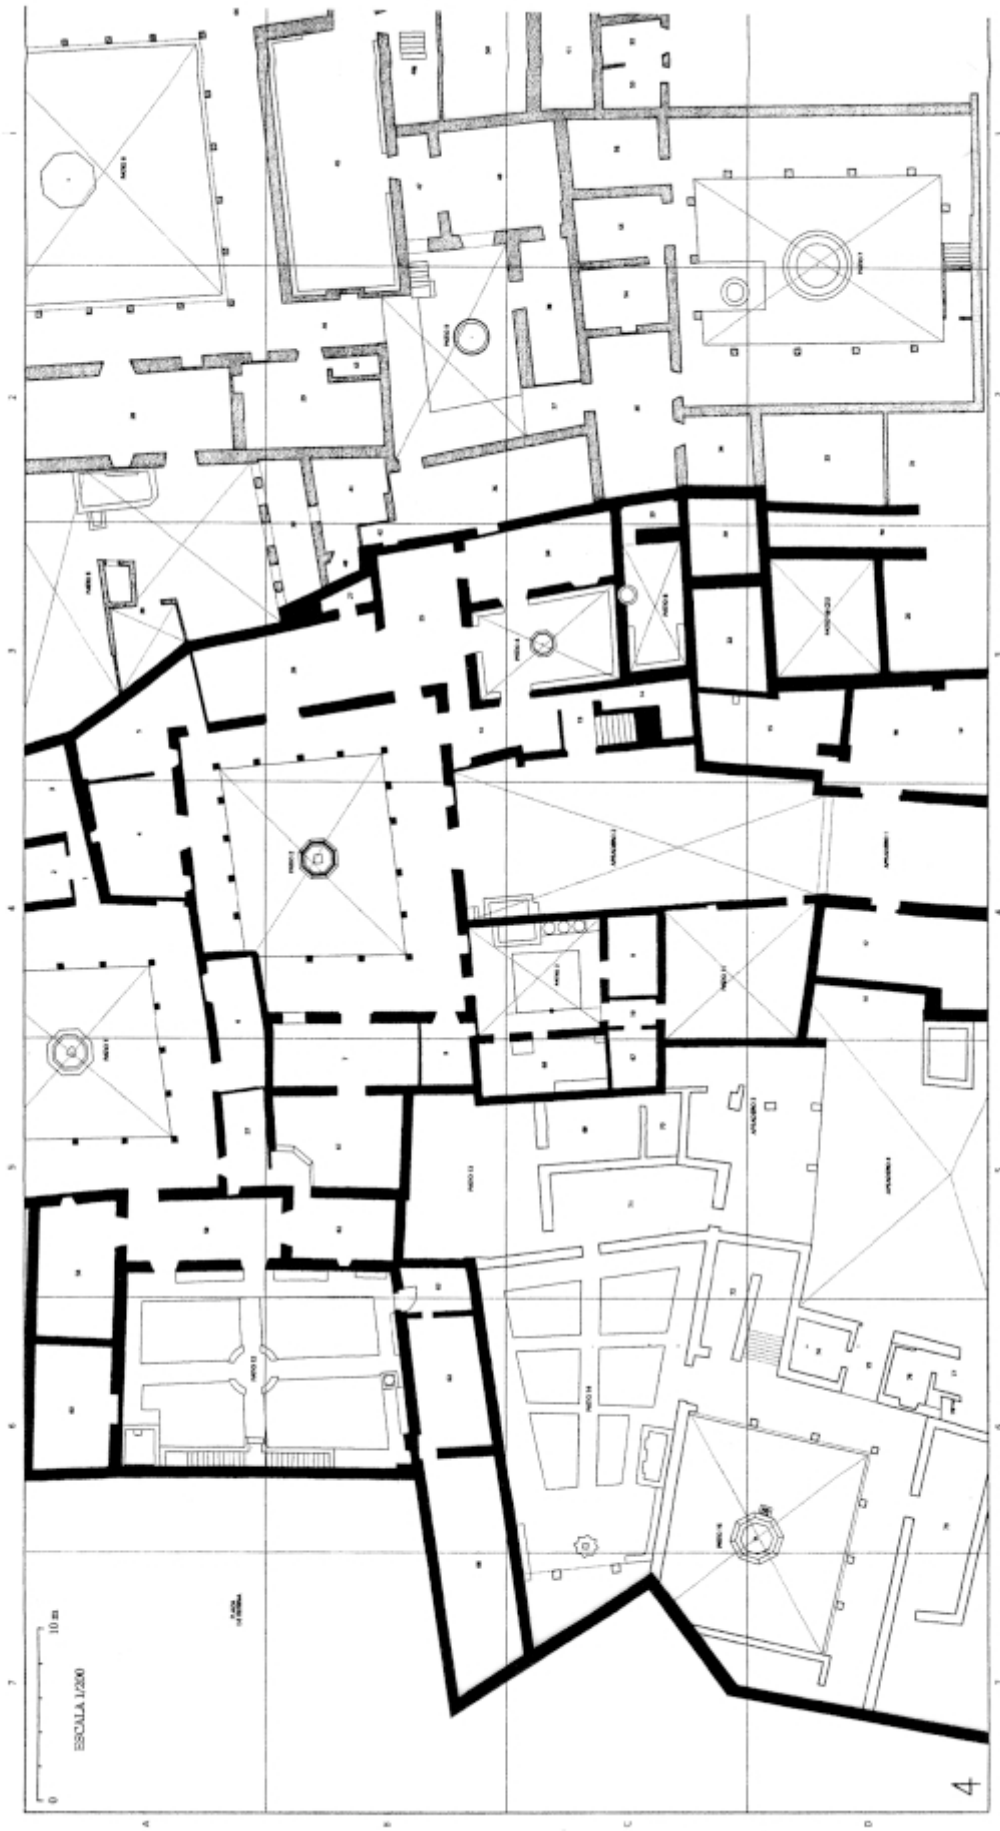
Planta de hipótesis de distribución arquitectónica de los restos excavados.
